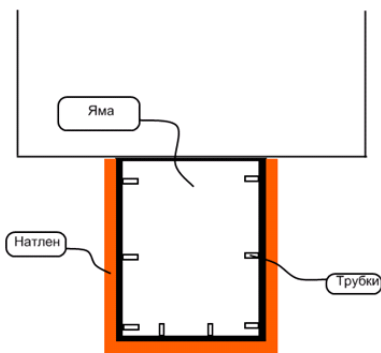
Гидроизоляция гаража с внешней стороны подвала
